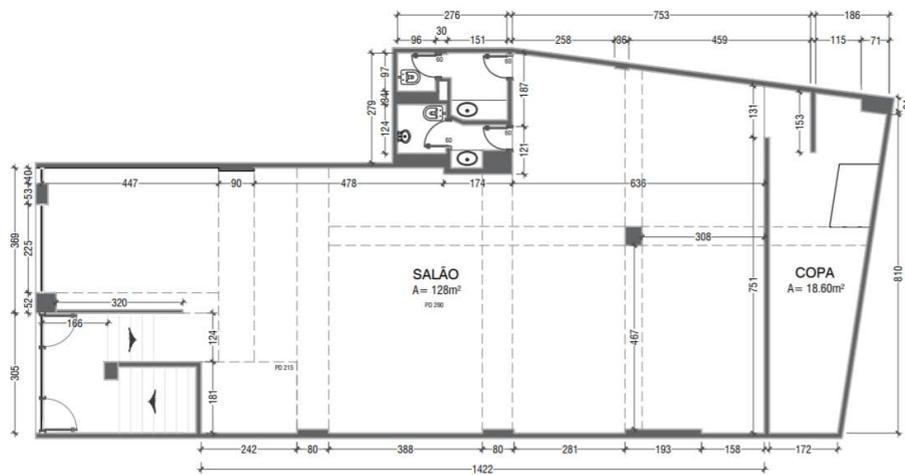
Planta do piso inferior. Fonte: AliasHouse
